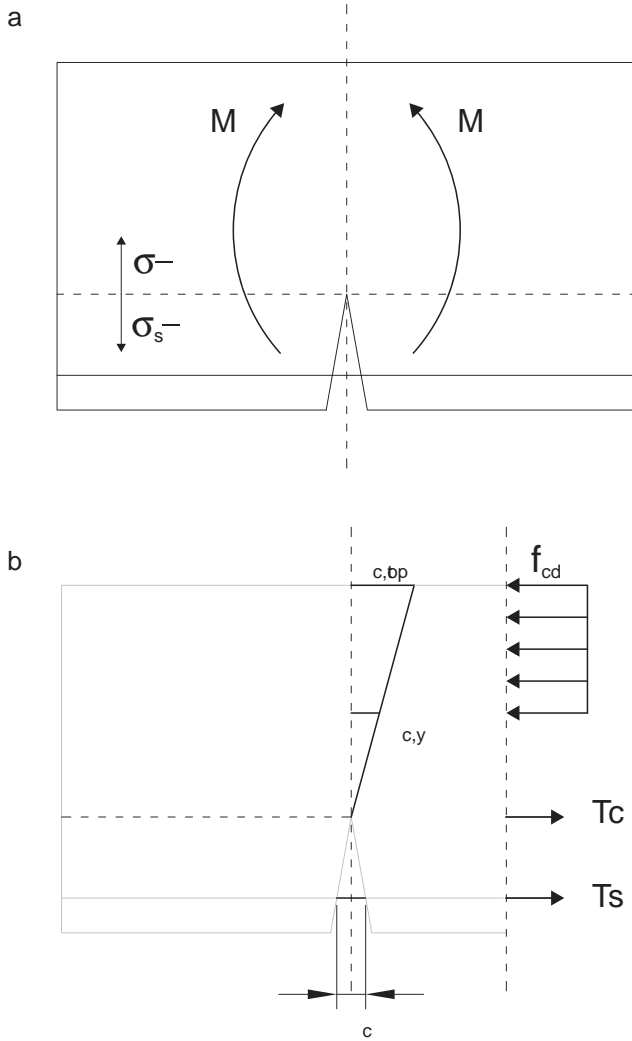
Criterios de fallo: a) zona fisurada-no fisurada; b) deformación en la zona comprimida.
